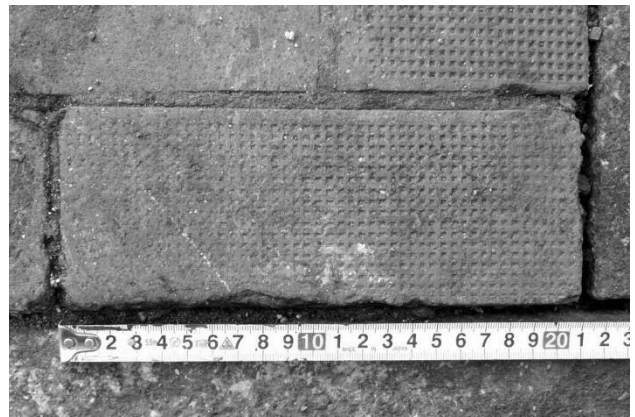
平面の格子模様（2021.12.7 樋口輝久撮影）
